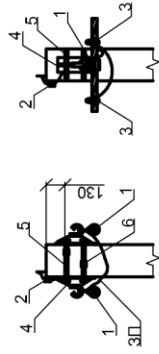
Лінійна арматура для монтажу ізолюваного проводу 0,4 кВ.
